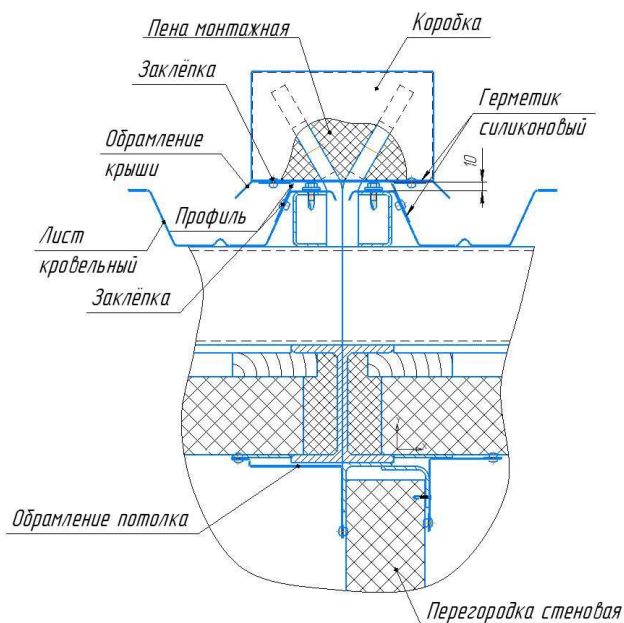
Стыковка крыш блоков с внутренней стеновой перегородкой
